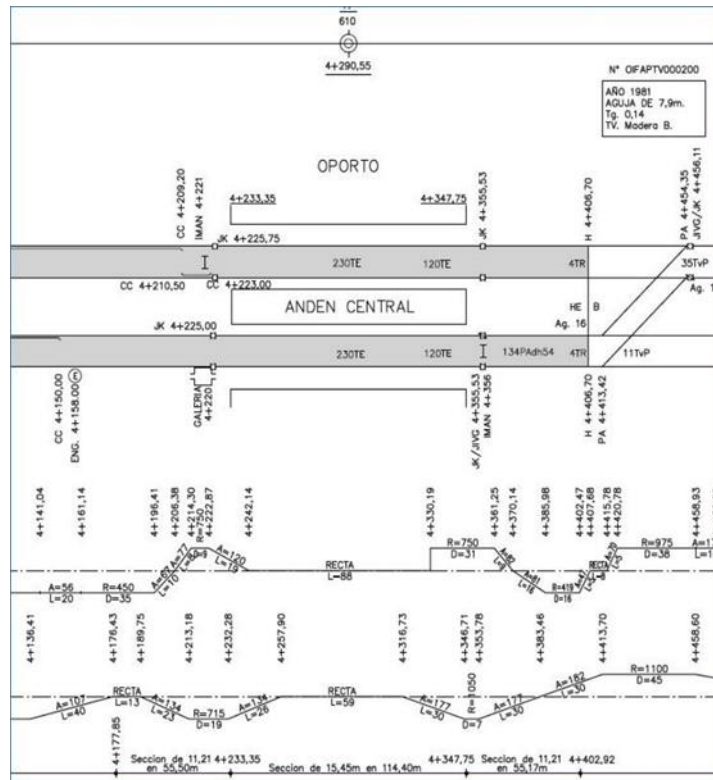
Ejemplo de planta esquemática de una estación con andén central de Metro de Madrid
